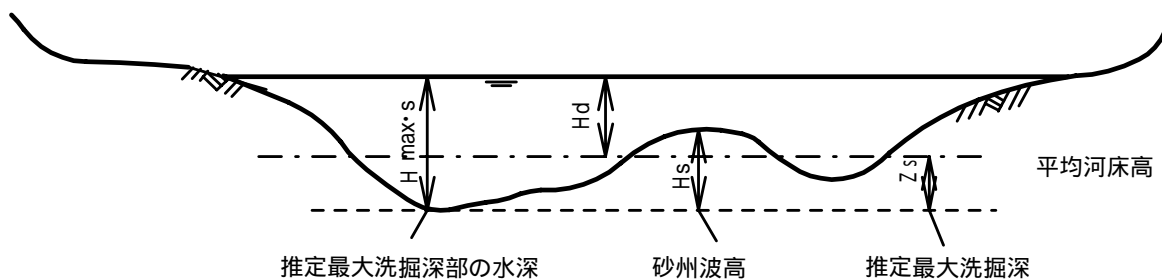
河床洗掘が砂州波高に支配される場合の断面説明図
